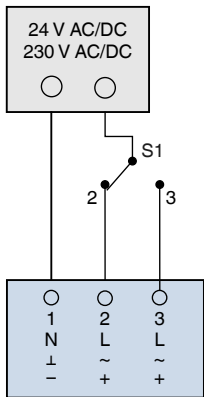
AUF/ZU-Steuerung mit Wechsler
